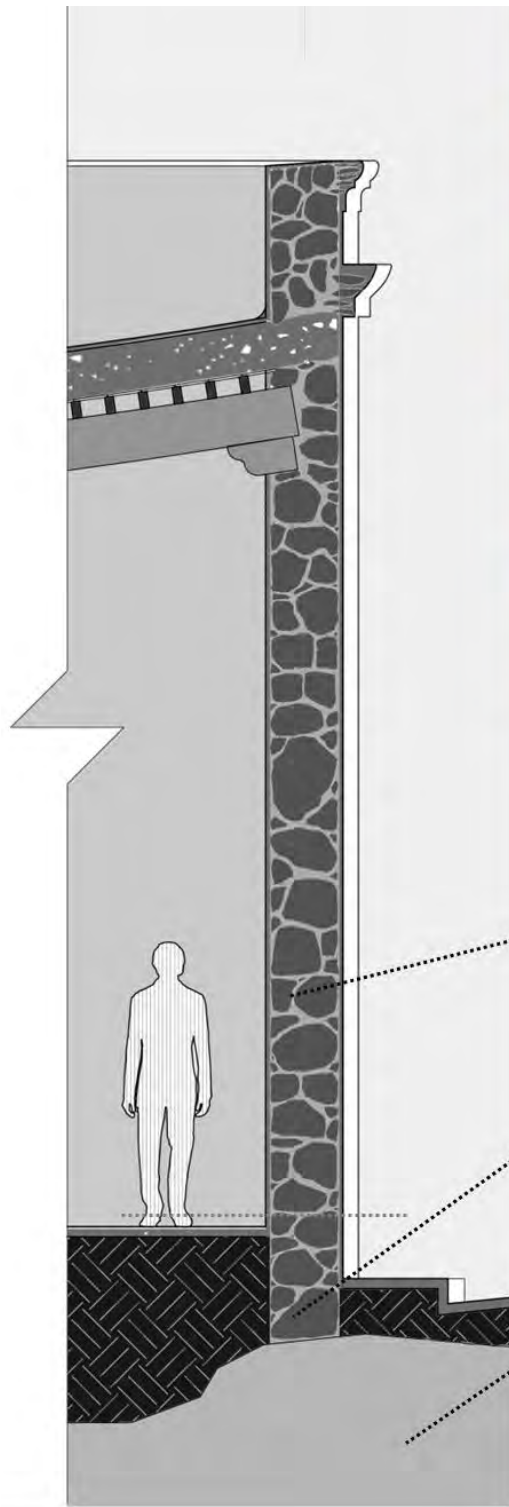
Detalle de la cimentación como continuación del muro de mampostería en una vivienda del siglo XIX en la calle 10 del barrio de San Francisco. Fuente: fotografía del autor, febrero de 2012.
